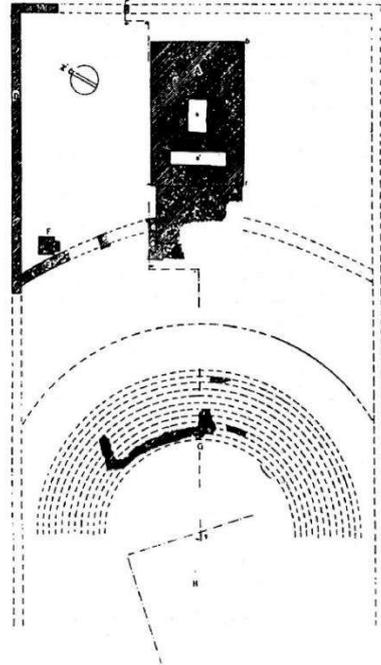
Theater-Ekklesiasterion mit möglicher Säulenhalle hinter dem Sitzhaus, Kassope (Ausschnitt Plan Emme 2013, 437 Tafel 49).
